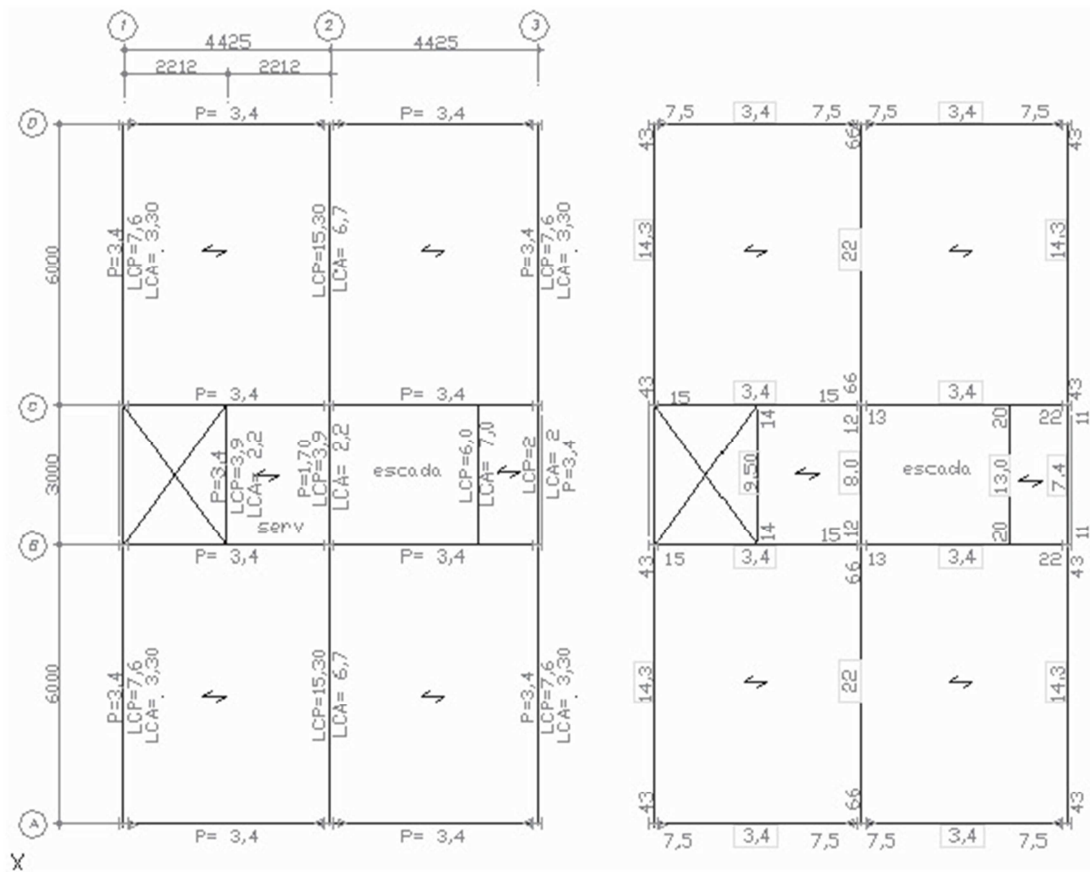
11 – Cargas nas vigas do pavimento tipo
